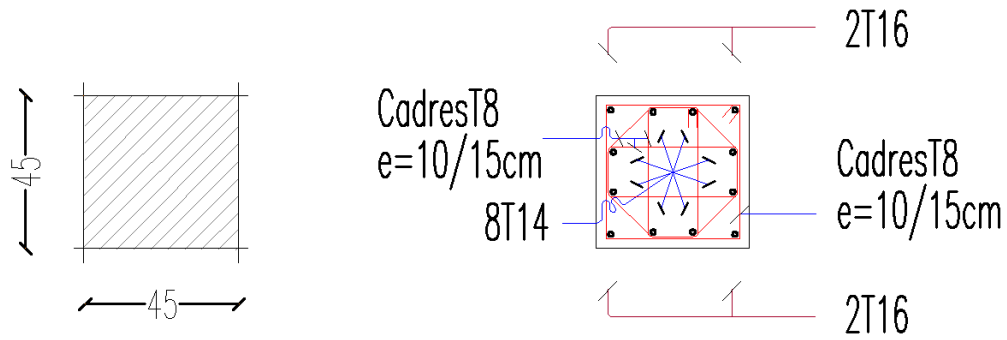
Schéma de ferrailage des poteaux 45x45
